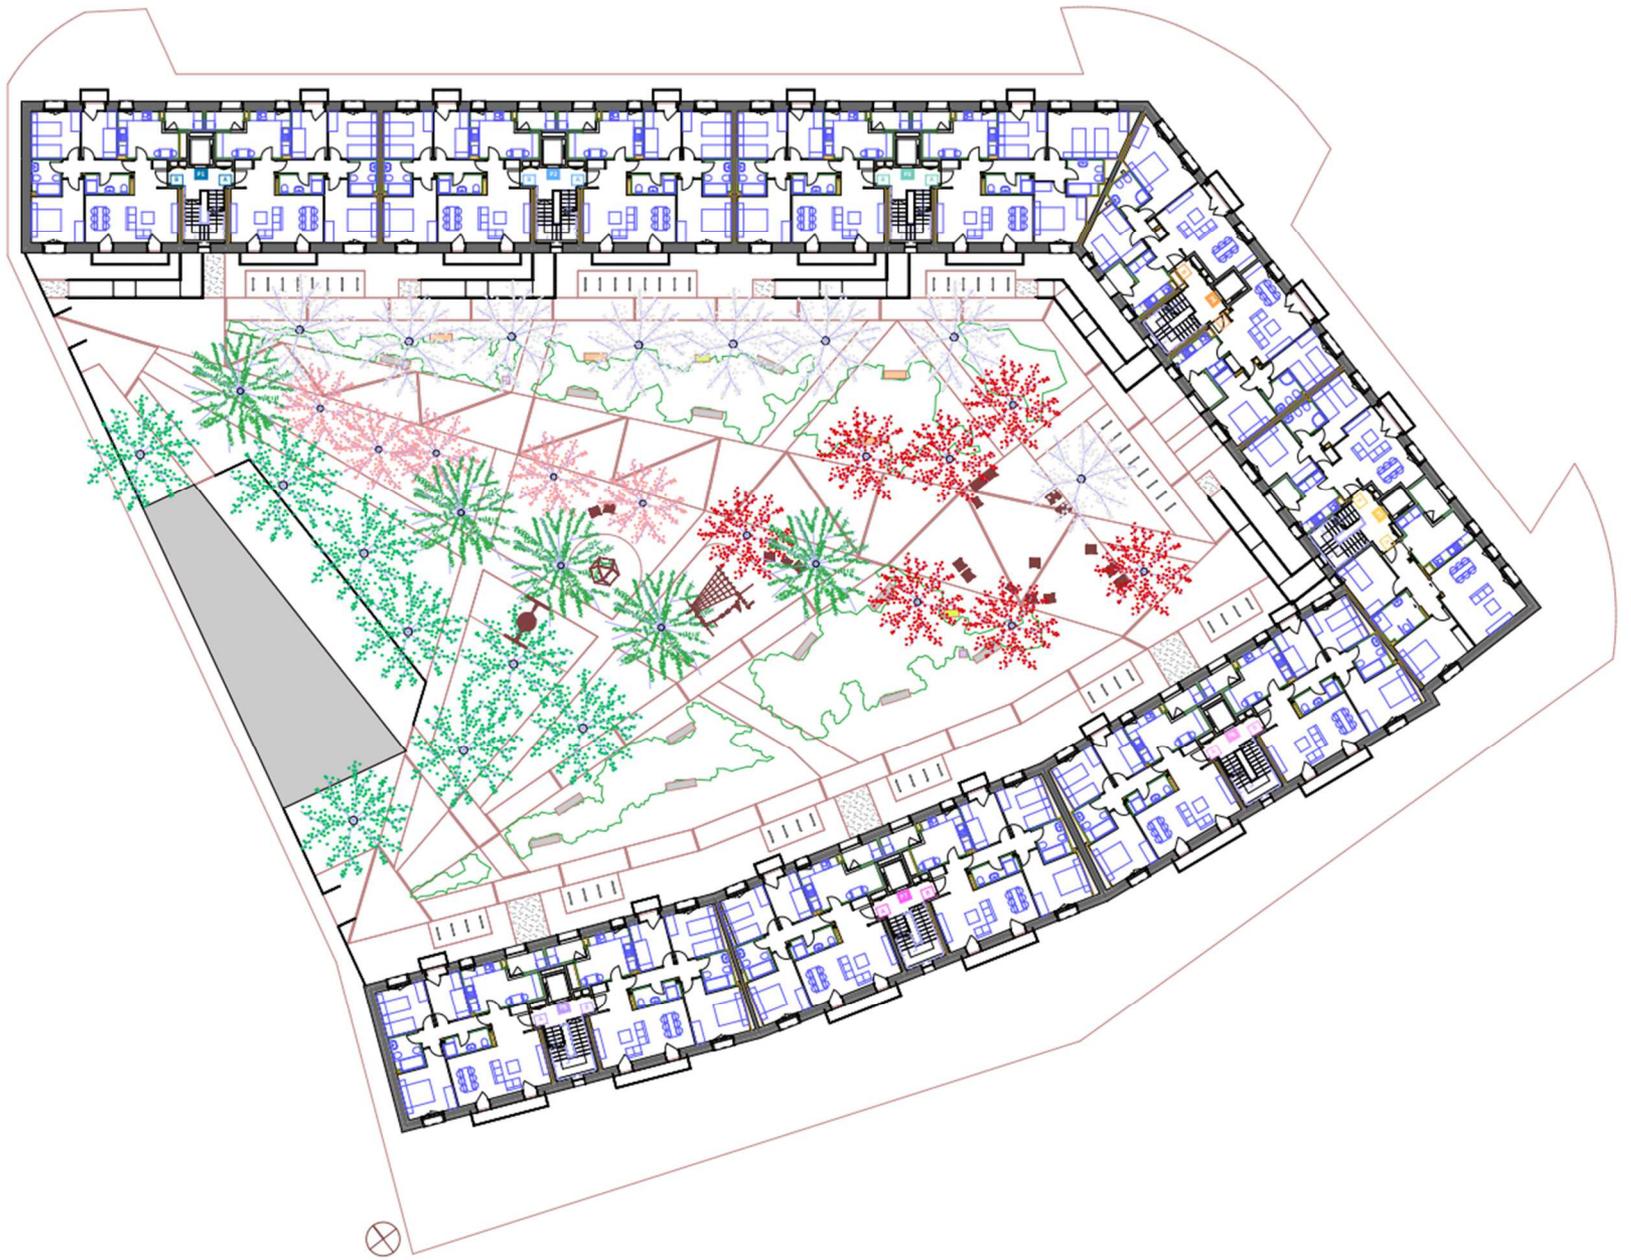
Planta Baja de las plantas Tipo 1, 2 y 3 de la Casa Cuartel del Puente Colgante
